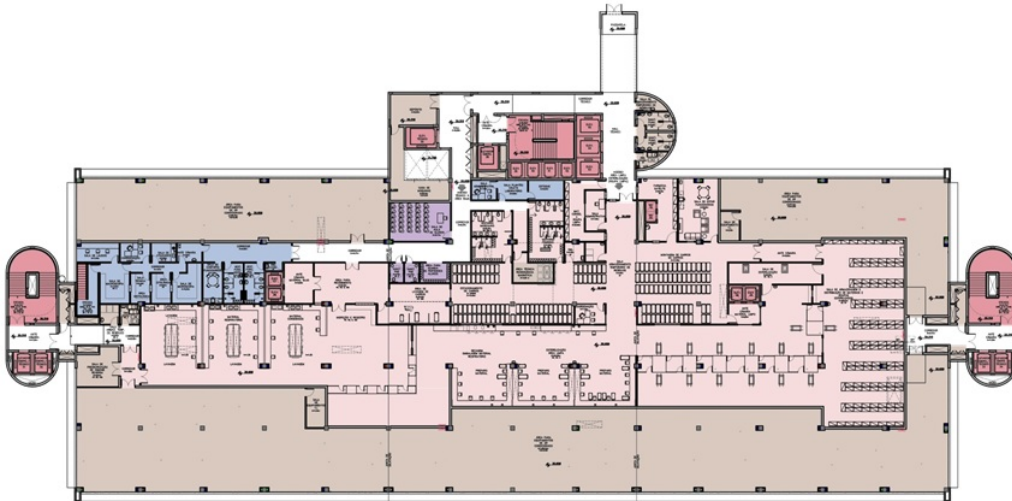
Anexo I - planta baixa do 5° pavimento. (Fonte: material de divulgação projeto de ampliação HCPA)
